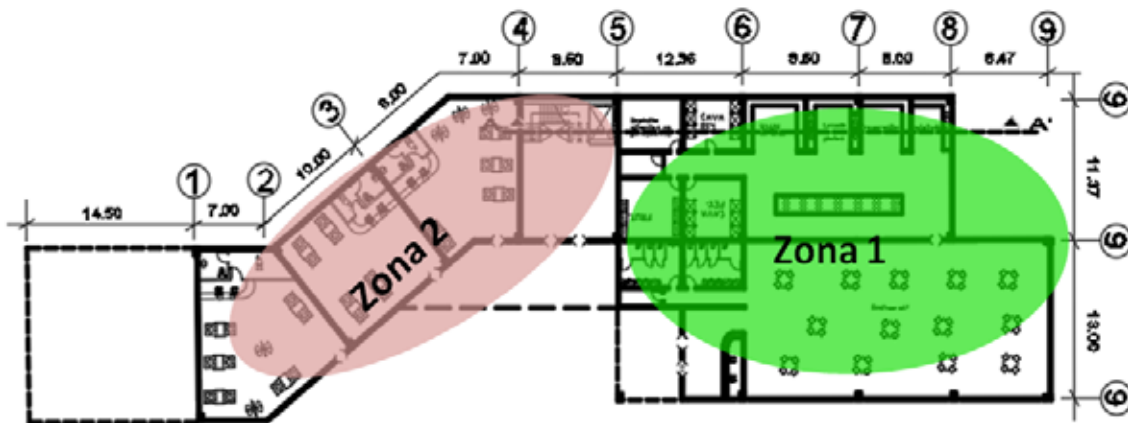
Planta baja edificación comercial N+654.00 (2017).
